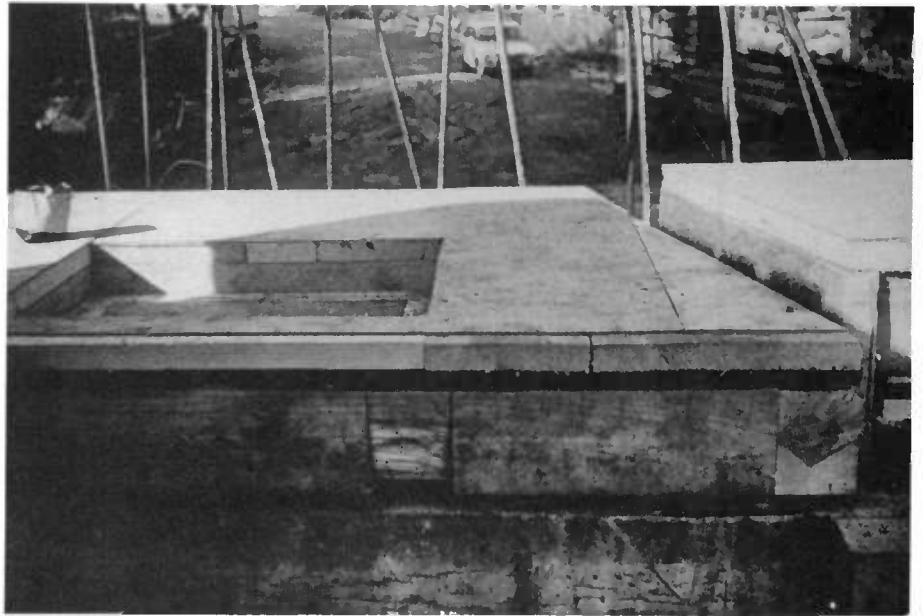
Méthode de la boîte à sable : coffrage terminé .
